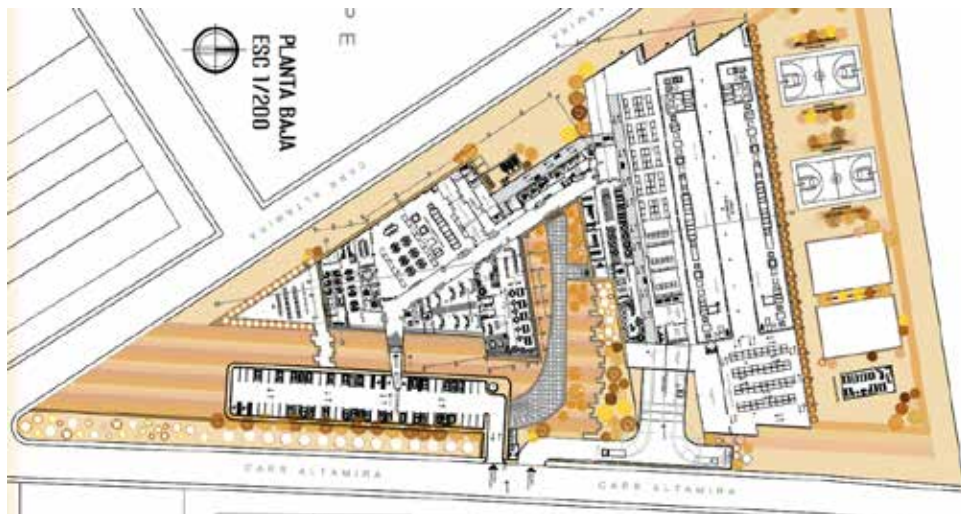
Planta Baja. Fuente: Analuja Robles. (2019).
